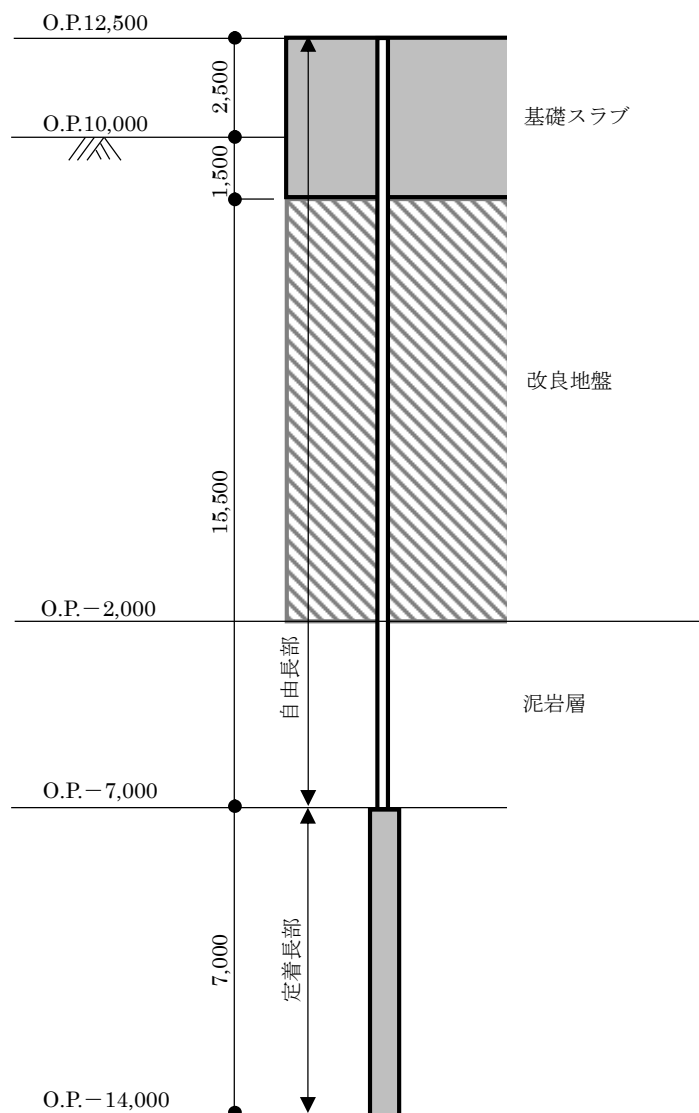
地盤アンカー設置計画 (単位：mm)
